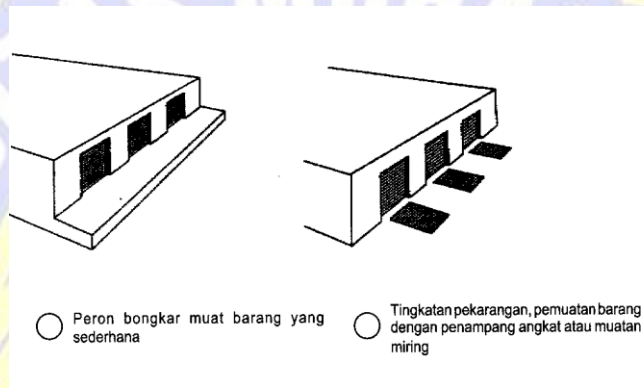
34 Standar Ruang untuk Kendaraan pada Loading Dock (NAD)
